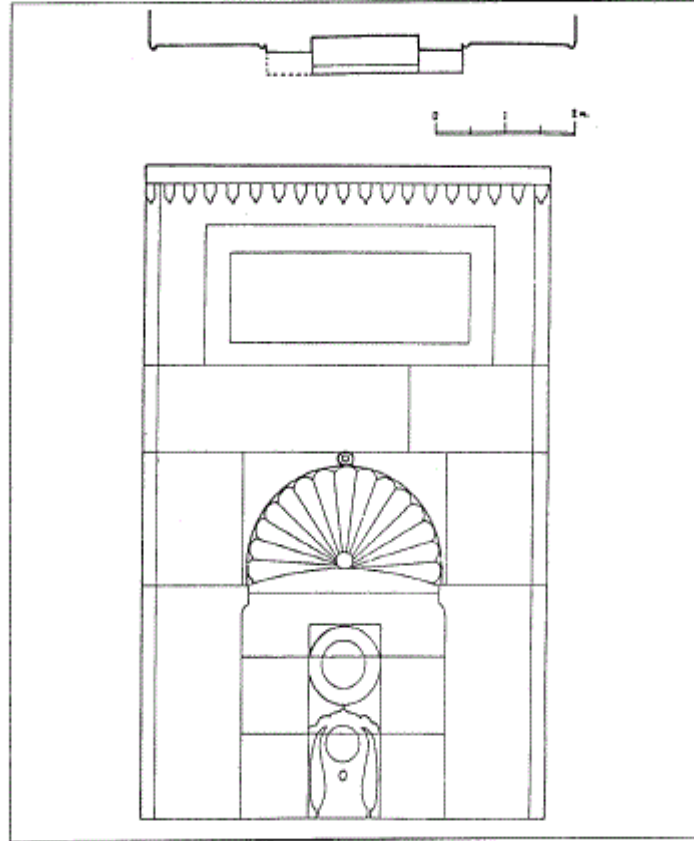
مسقط أفقي لحشمة غلبهار خاتون أدرنة (عن: ÖNGE).
